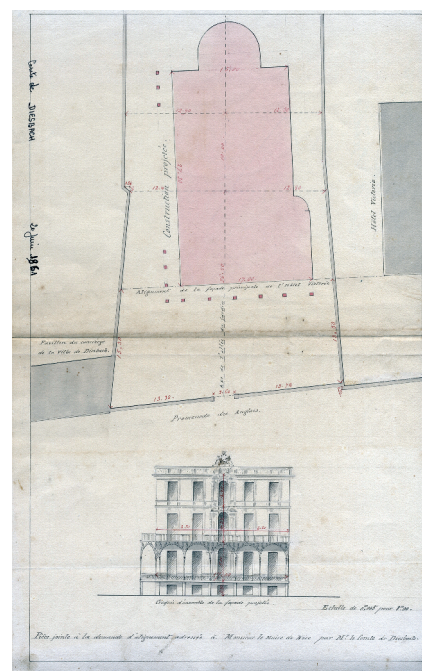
Plan et croquis d'ensemble de la façade projetée, Demande du comte de Diesbach pour construire un pavillon, promenade des Anglais, 1861.
